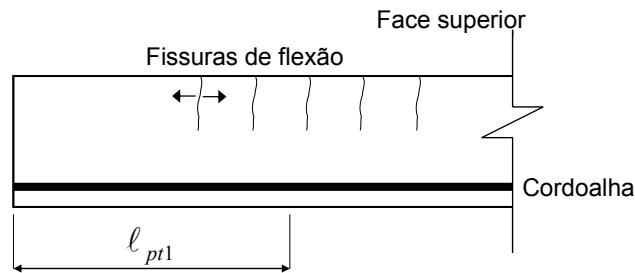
Fissuras de tração que ocorrem na face superior da laje devidas à protensão.
